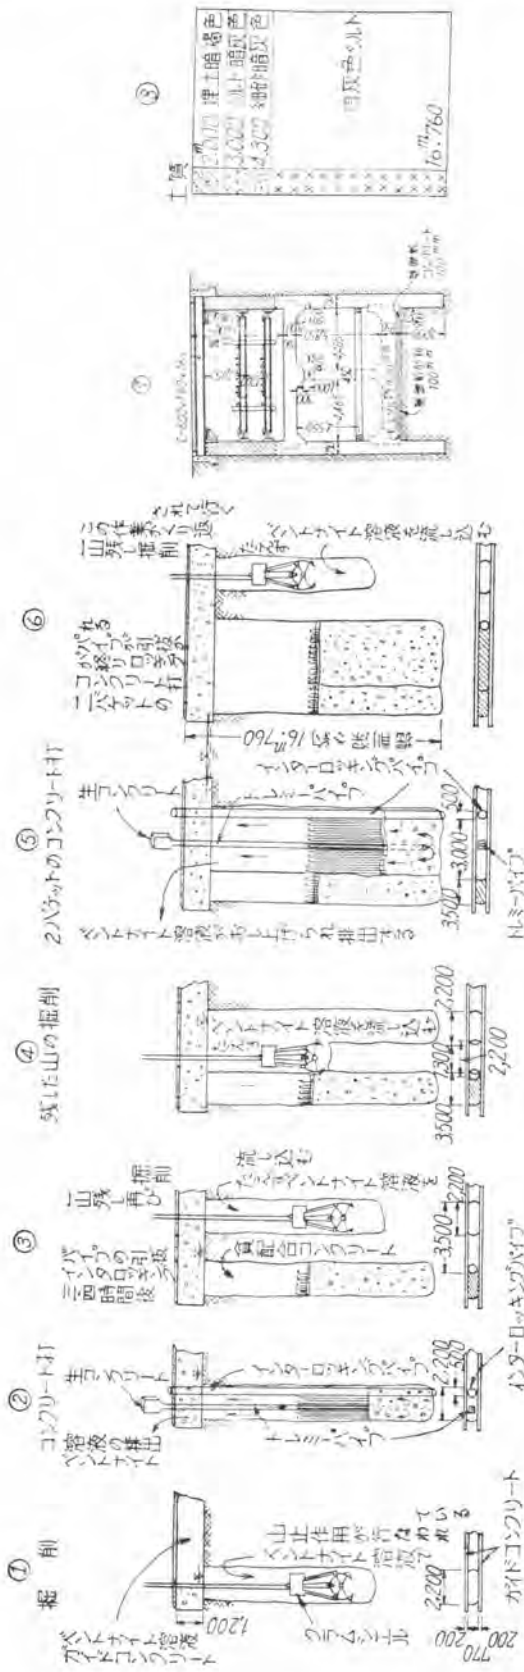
イコス工法による掘削およびコンクリート打設順序説明図
